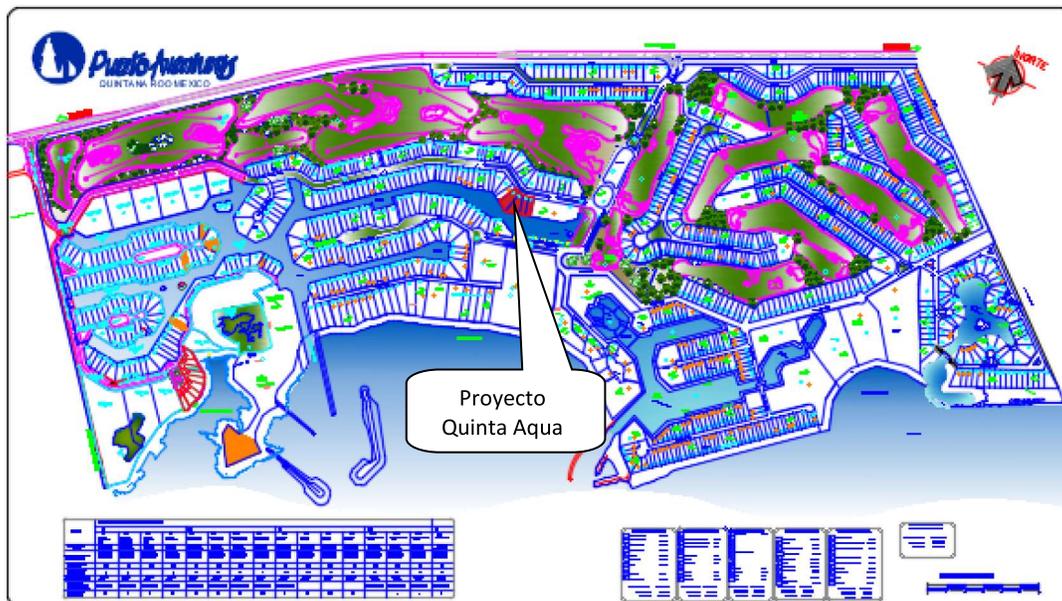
Ubicación del predio del proyecto sobre el Plano de Puerto Aventuras
